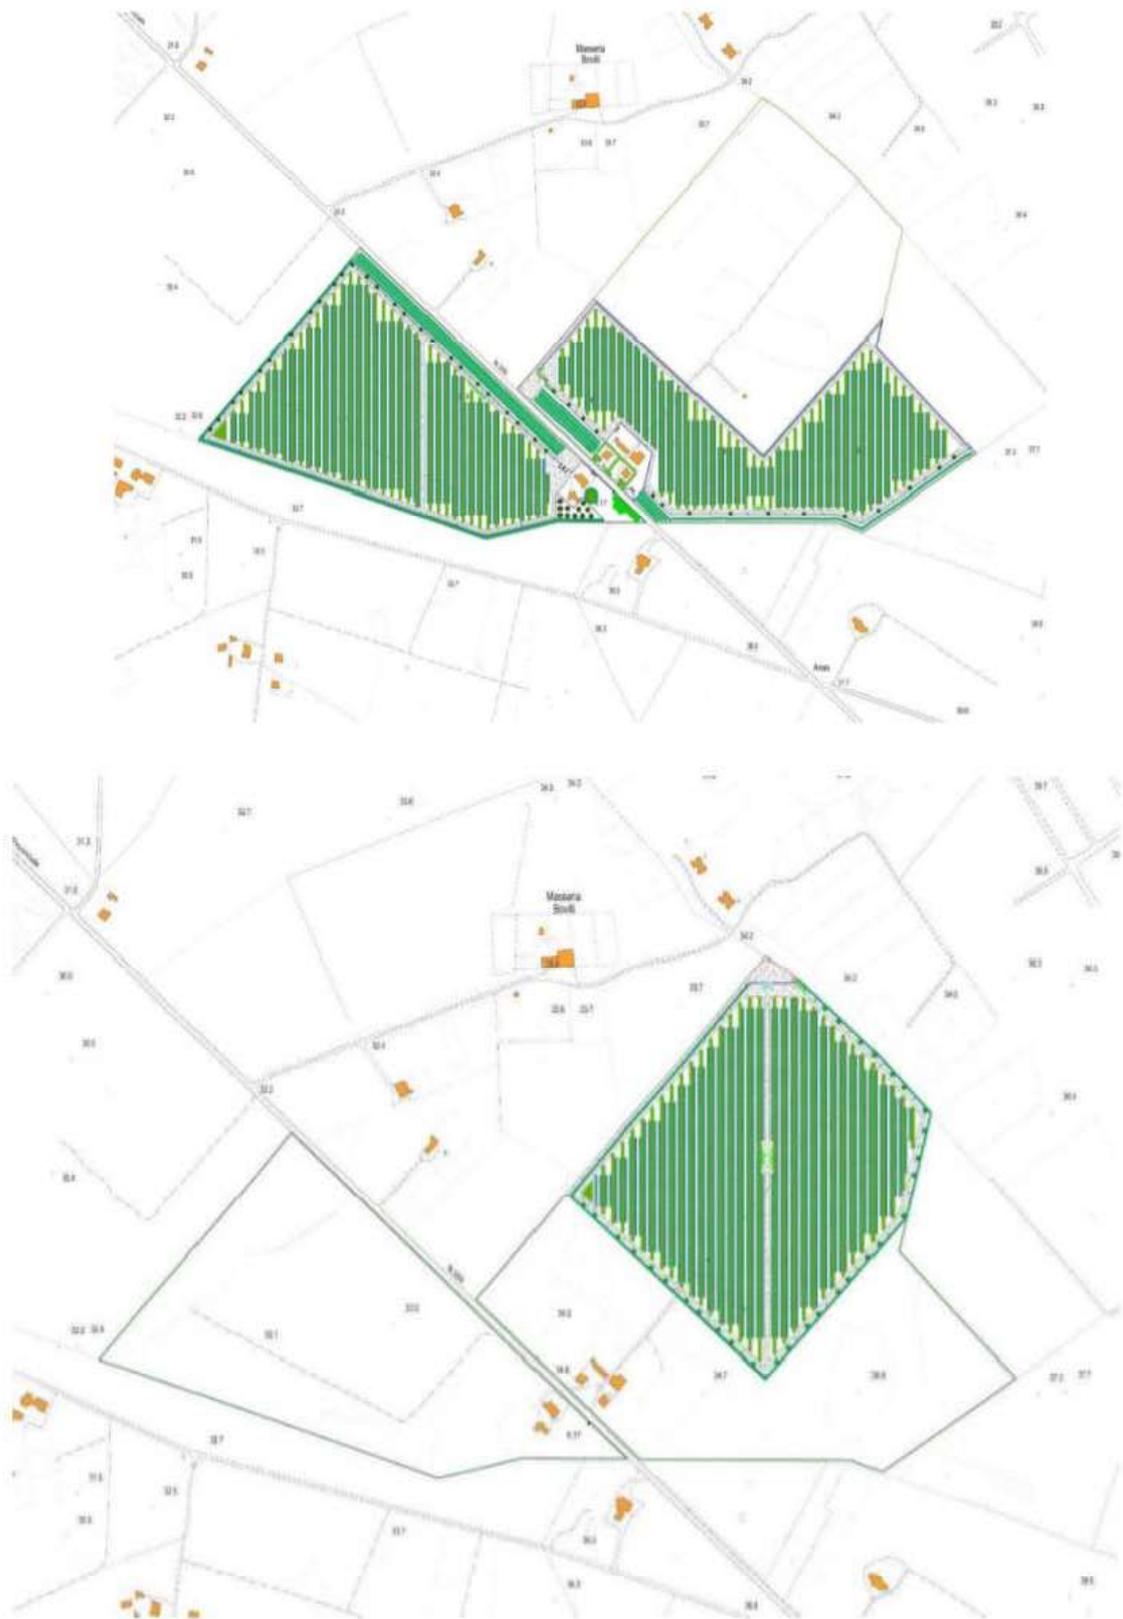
Stralcio layout “Builli 1” e “Builli 2”
